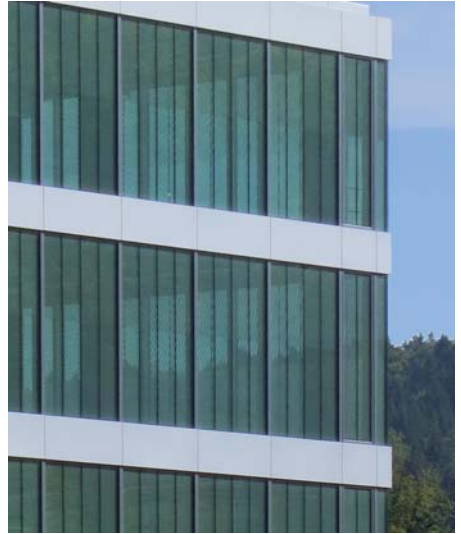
Pharma 2020 Neubau Produktion, Sulzbach-Laufen. Arch: Koppenhöfer + Partner GmbH, Stuttgart. Alu-Konstruktion mit Tageslichtlenkung Typ RETROLuxTherm 20 mm im Isolierglas in Kombination mit einer Verglasung 50/25, ideal für großflächige Fassaden.
